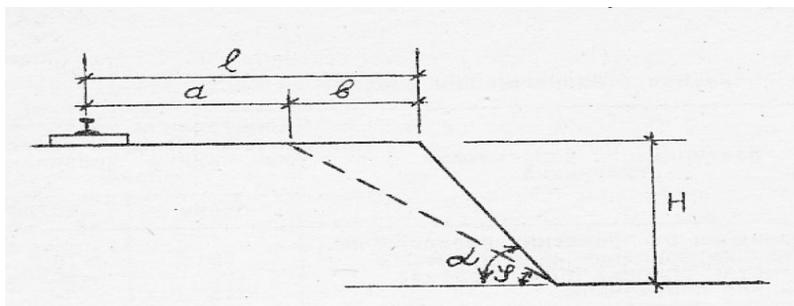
Безопасное расстояние оси подкранового рельса от верха бровки котлована.
